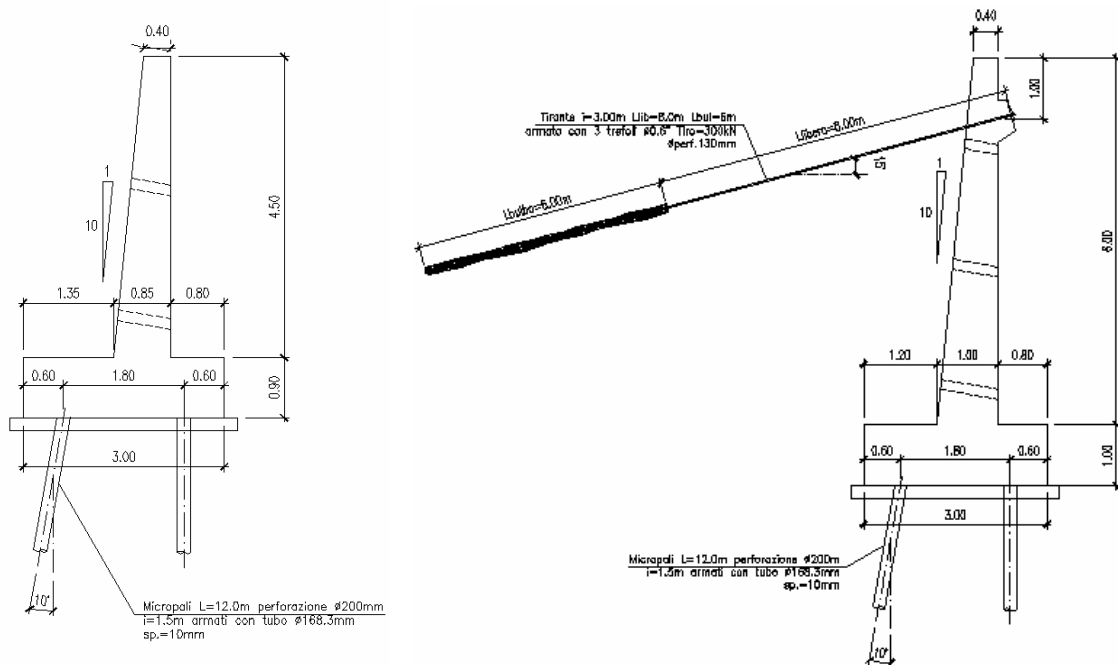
TIPO 3 e TIPO 4: sezione trasversale muri
